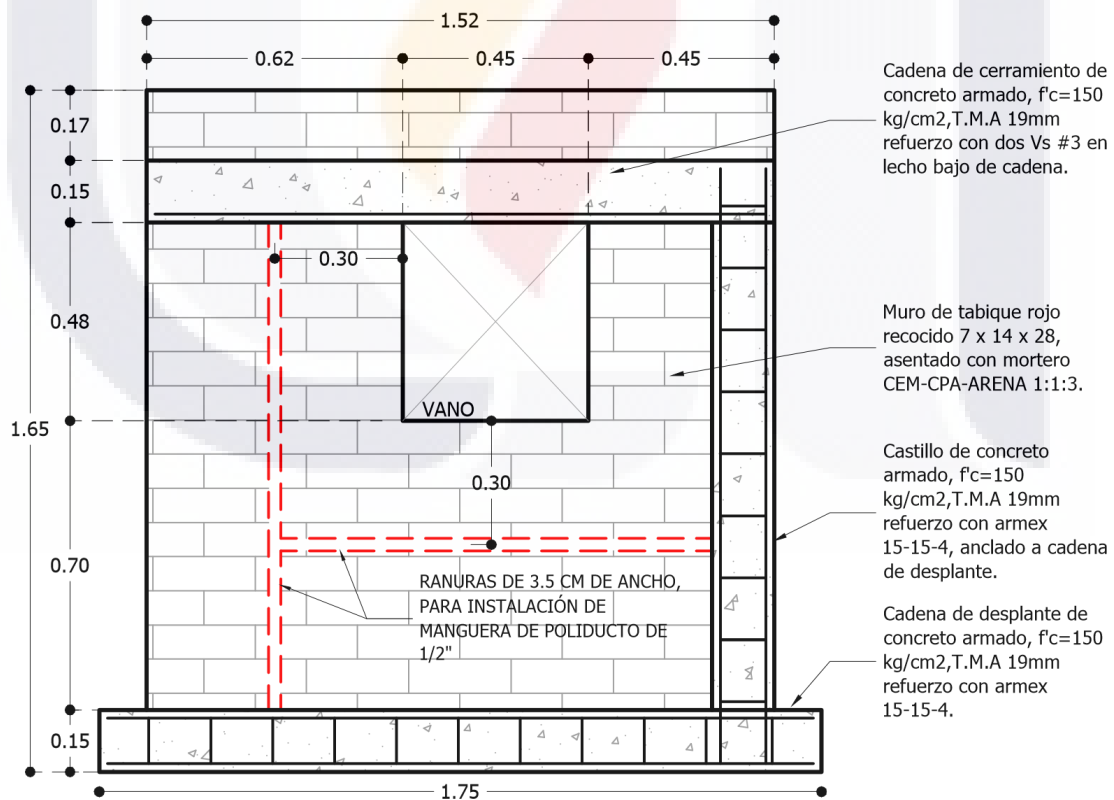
Detalle constructivo de diseño de MTR 1 Cara A
